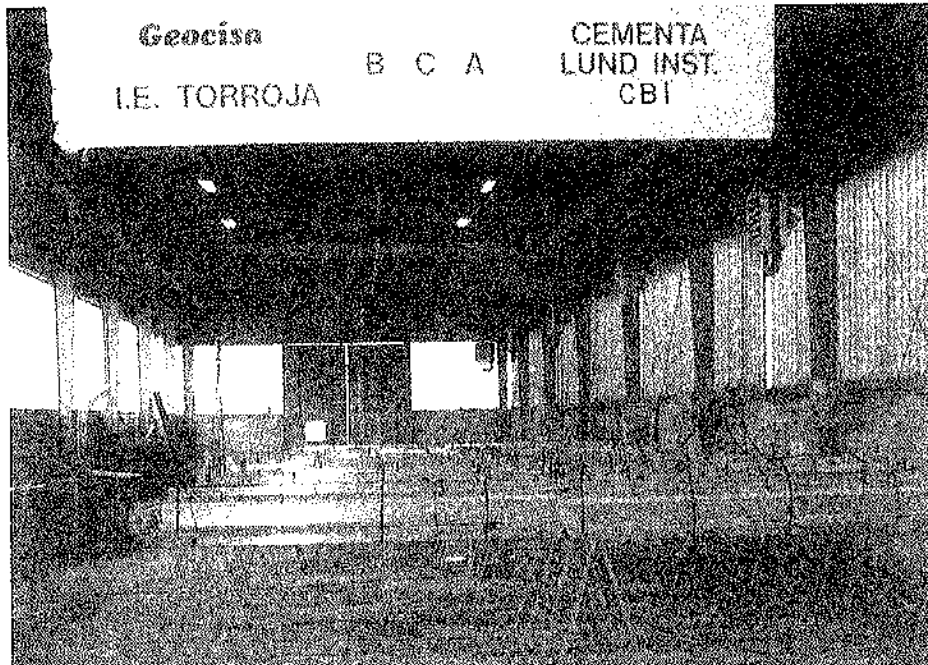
Vista del parque de vigas durante la corrosión acelerada de sus armaduras.
